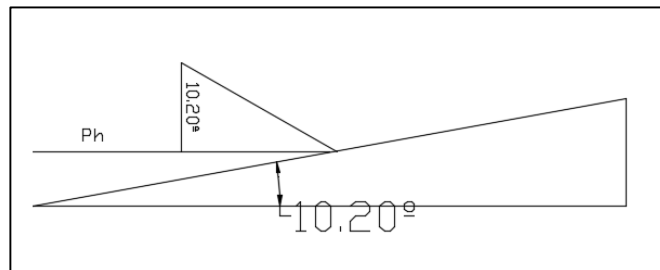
Esfuerzo horizontal del viento aplicado a la cubierta.
